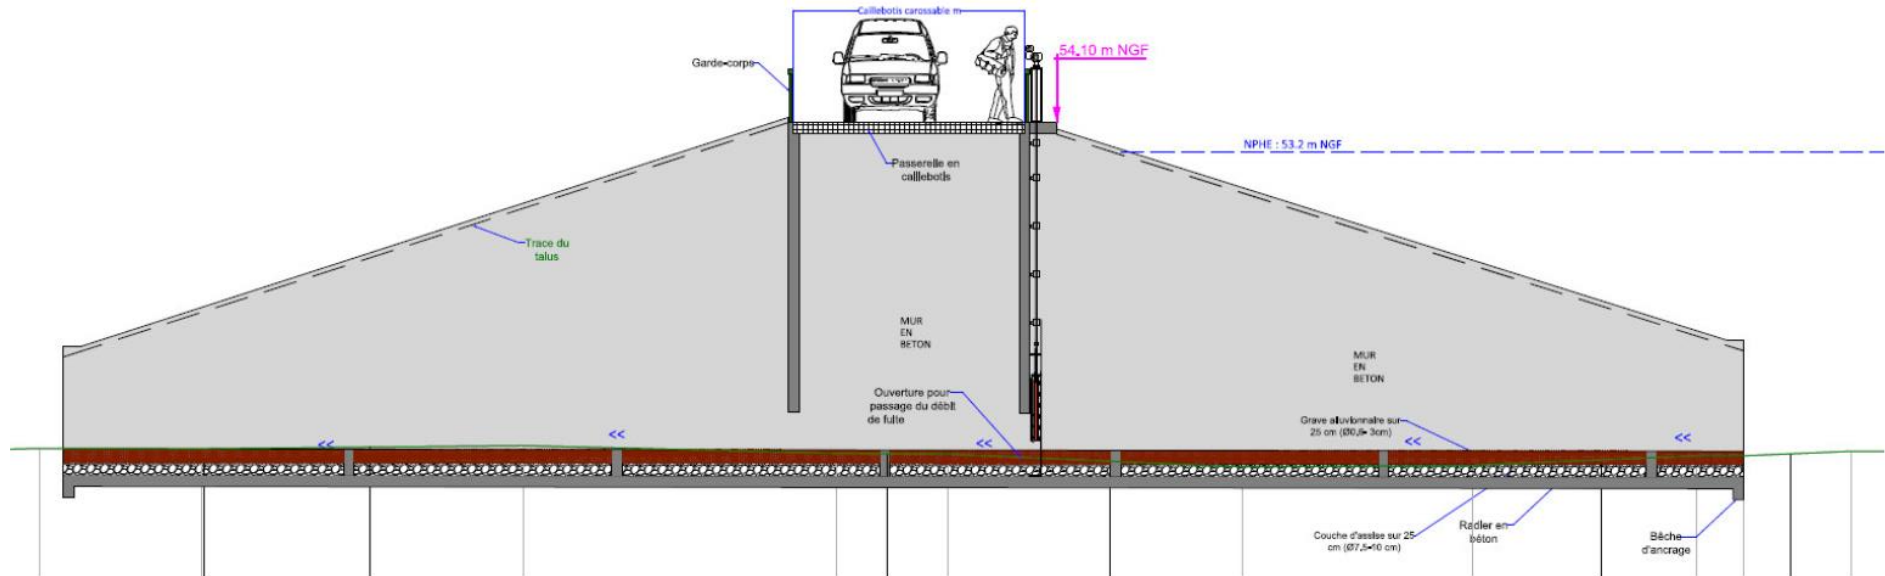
Coupe type de l'ouvrage de Muirancourt section courante et lit mineur (source AVP Antea)
